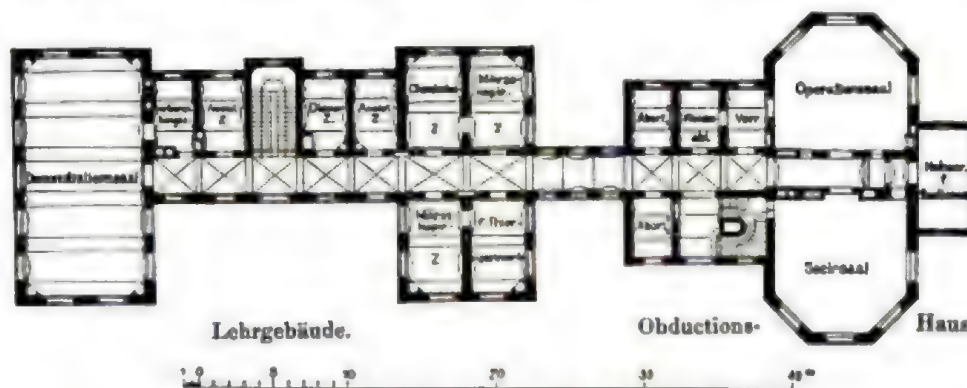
Grundriss vom ersten Stockwerk.
